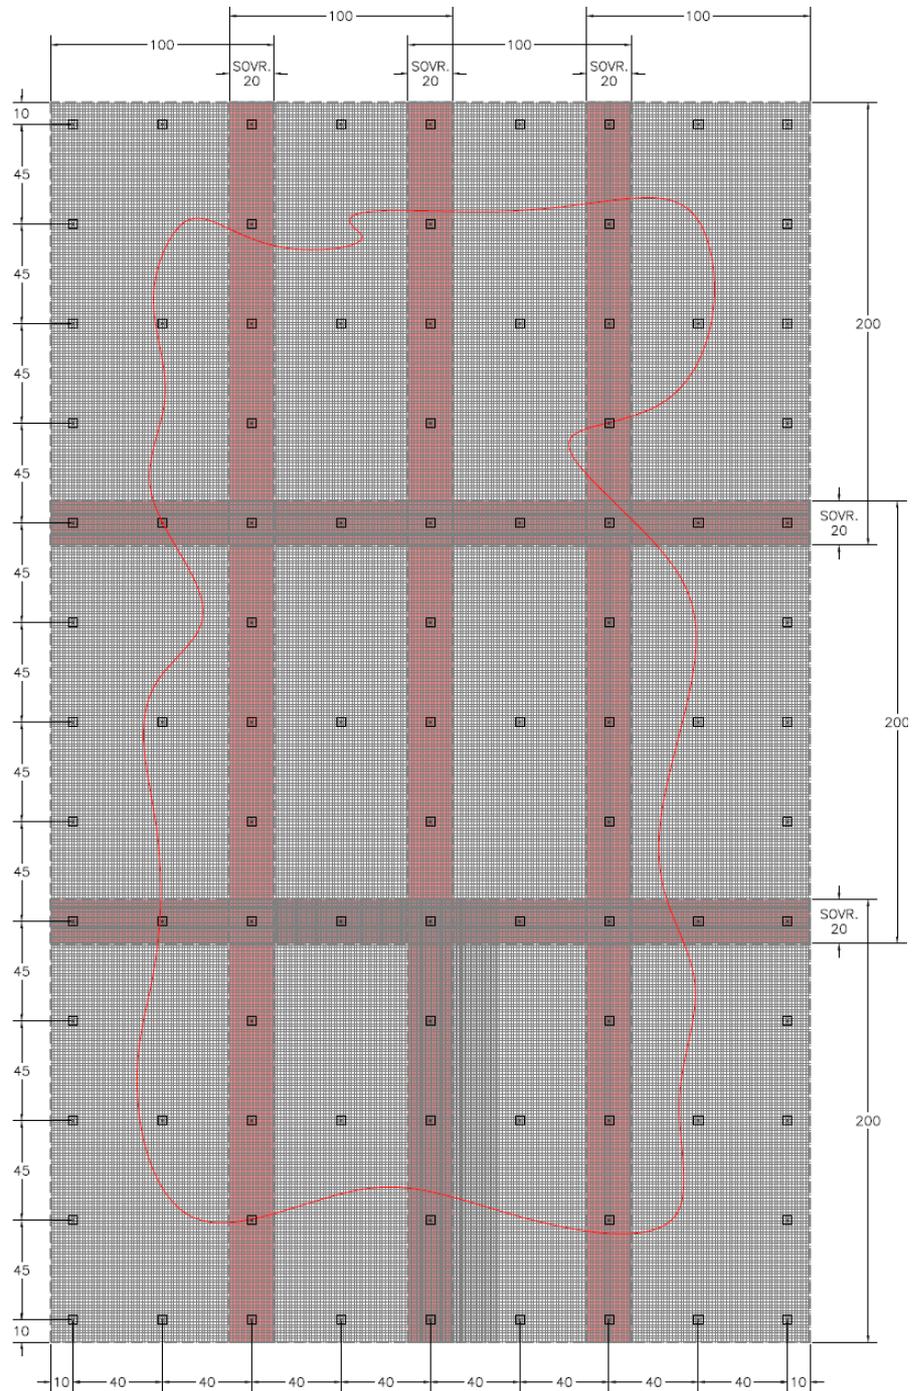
Schema disposizione tasselli pannelli 1x2 m
